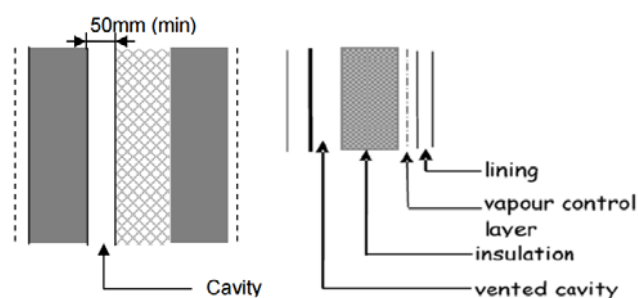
Muro tipo C: Cerramiento vertical de dos hojas y con relleno parcial de aislamiento. (Technical Booklet C)
